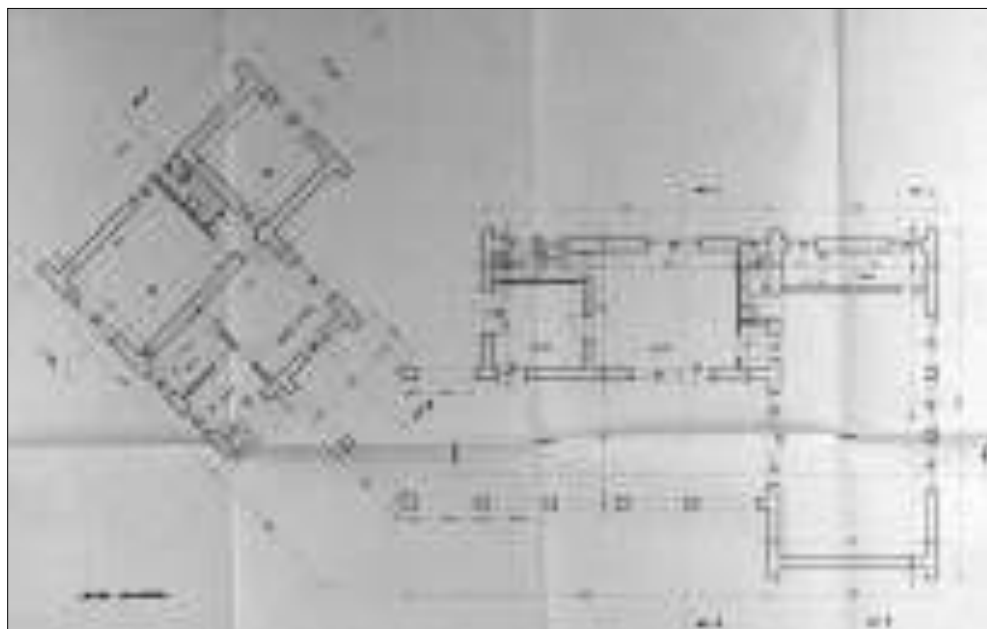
Pianta dello spaccio del borgo di Serramarina (MT) – Archivio ERSAP
